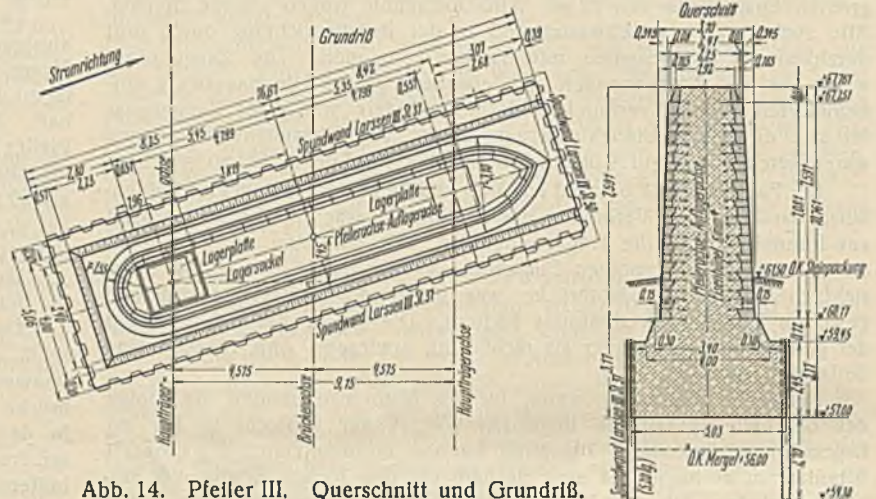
Pfeiler III. Querschnitt und Grundriß.
